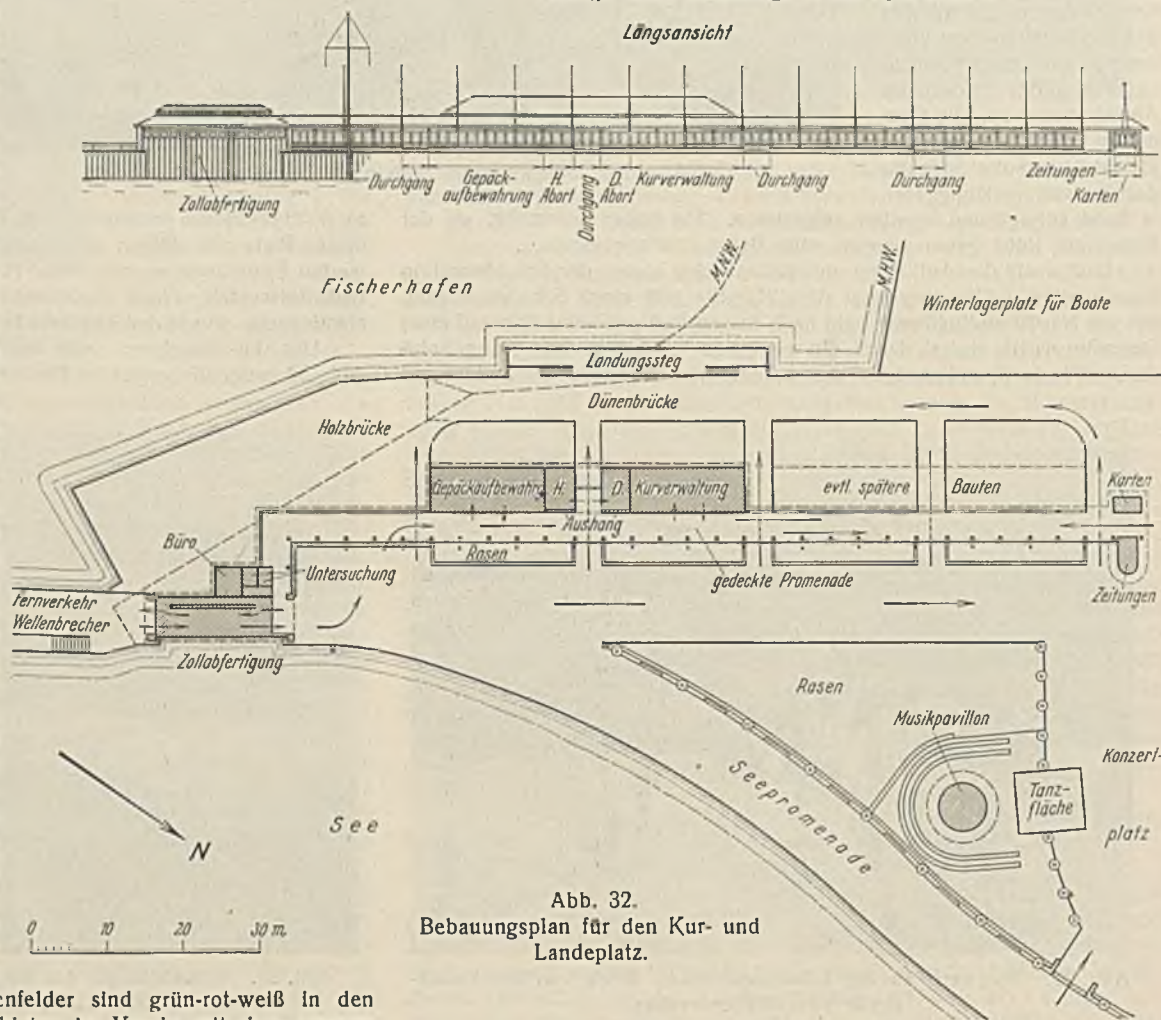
Bebauungsplan für den Kur- und Landeplatz.
